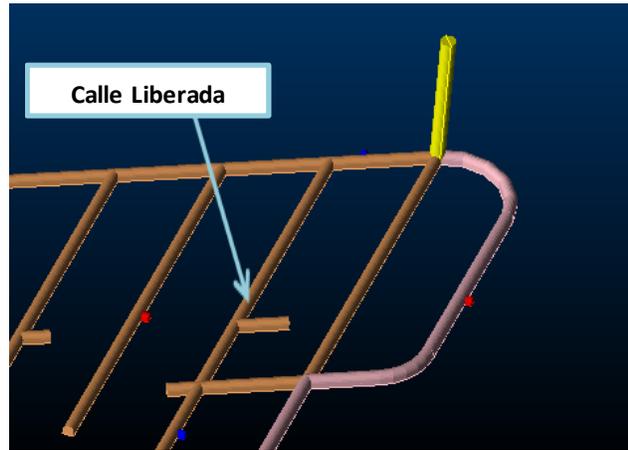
Consideraciones de Constructibilidad, Perforación de Pozos
